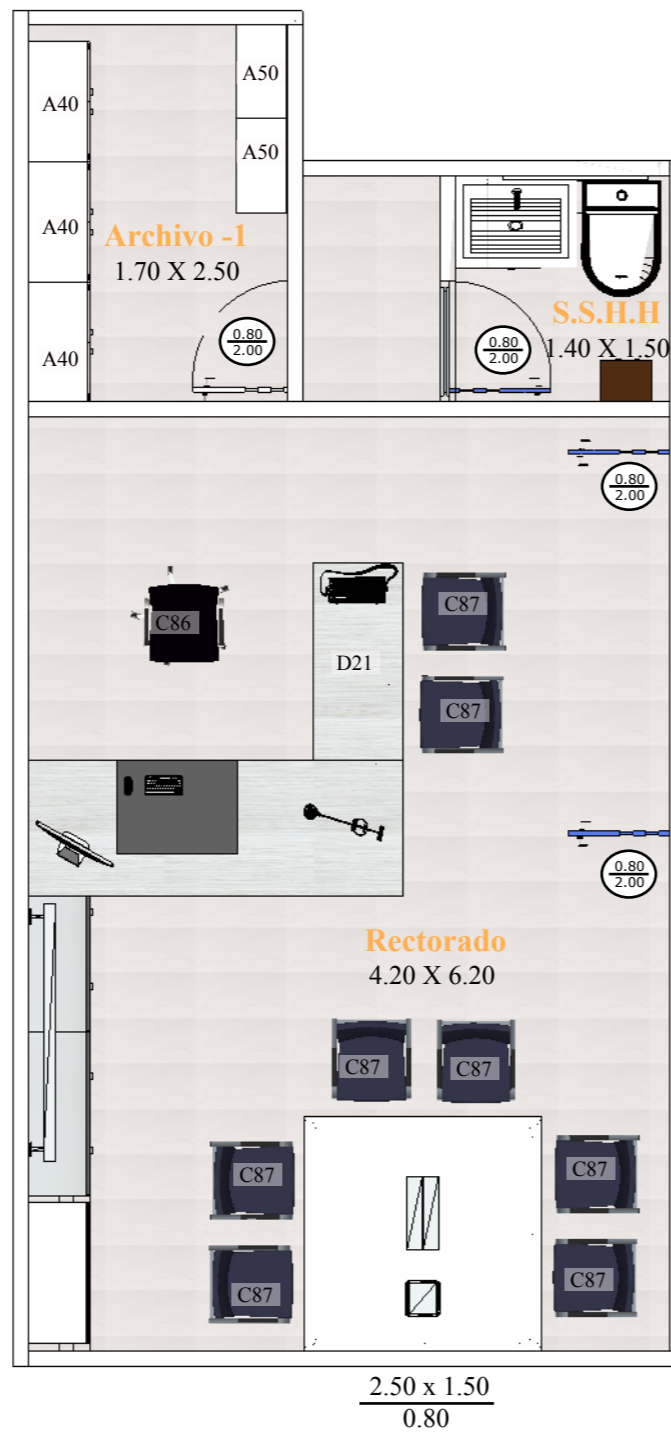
Planta Decorativa Rectorado, Archivo-1 y S.H. Privado
